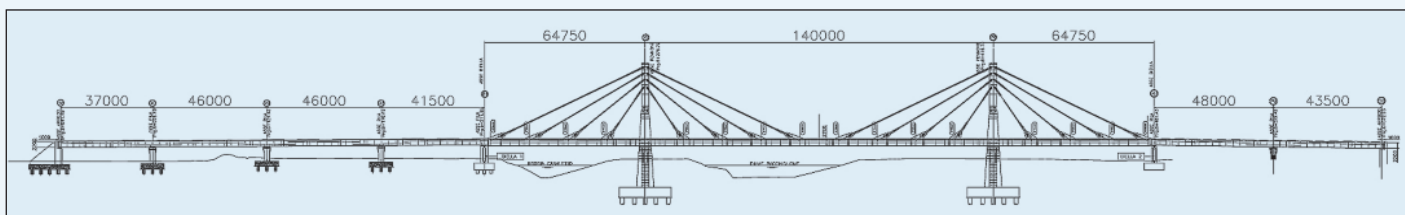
La vista dei viadotti di accesso e del ponte strallato
